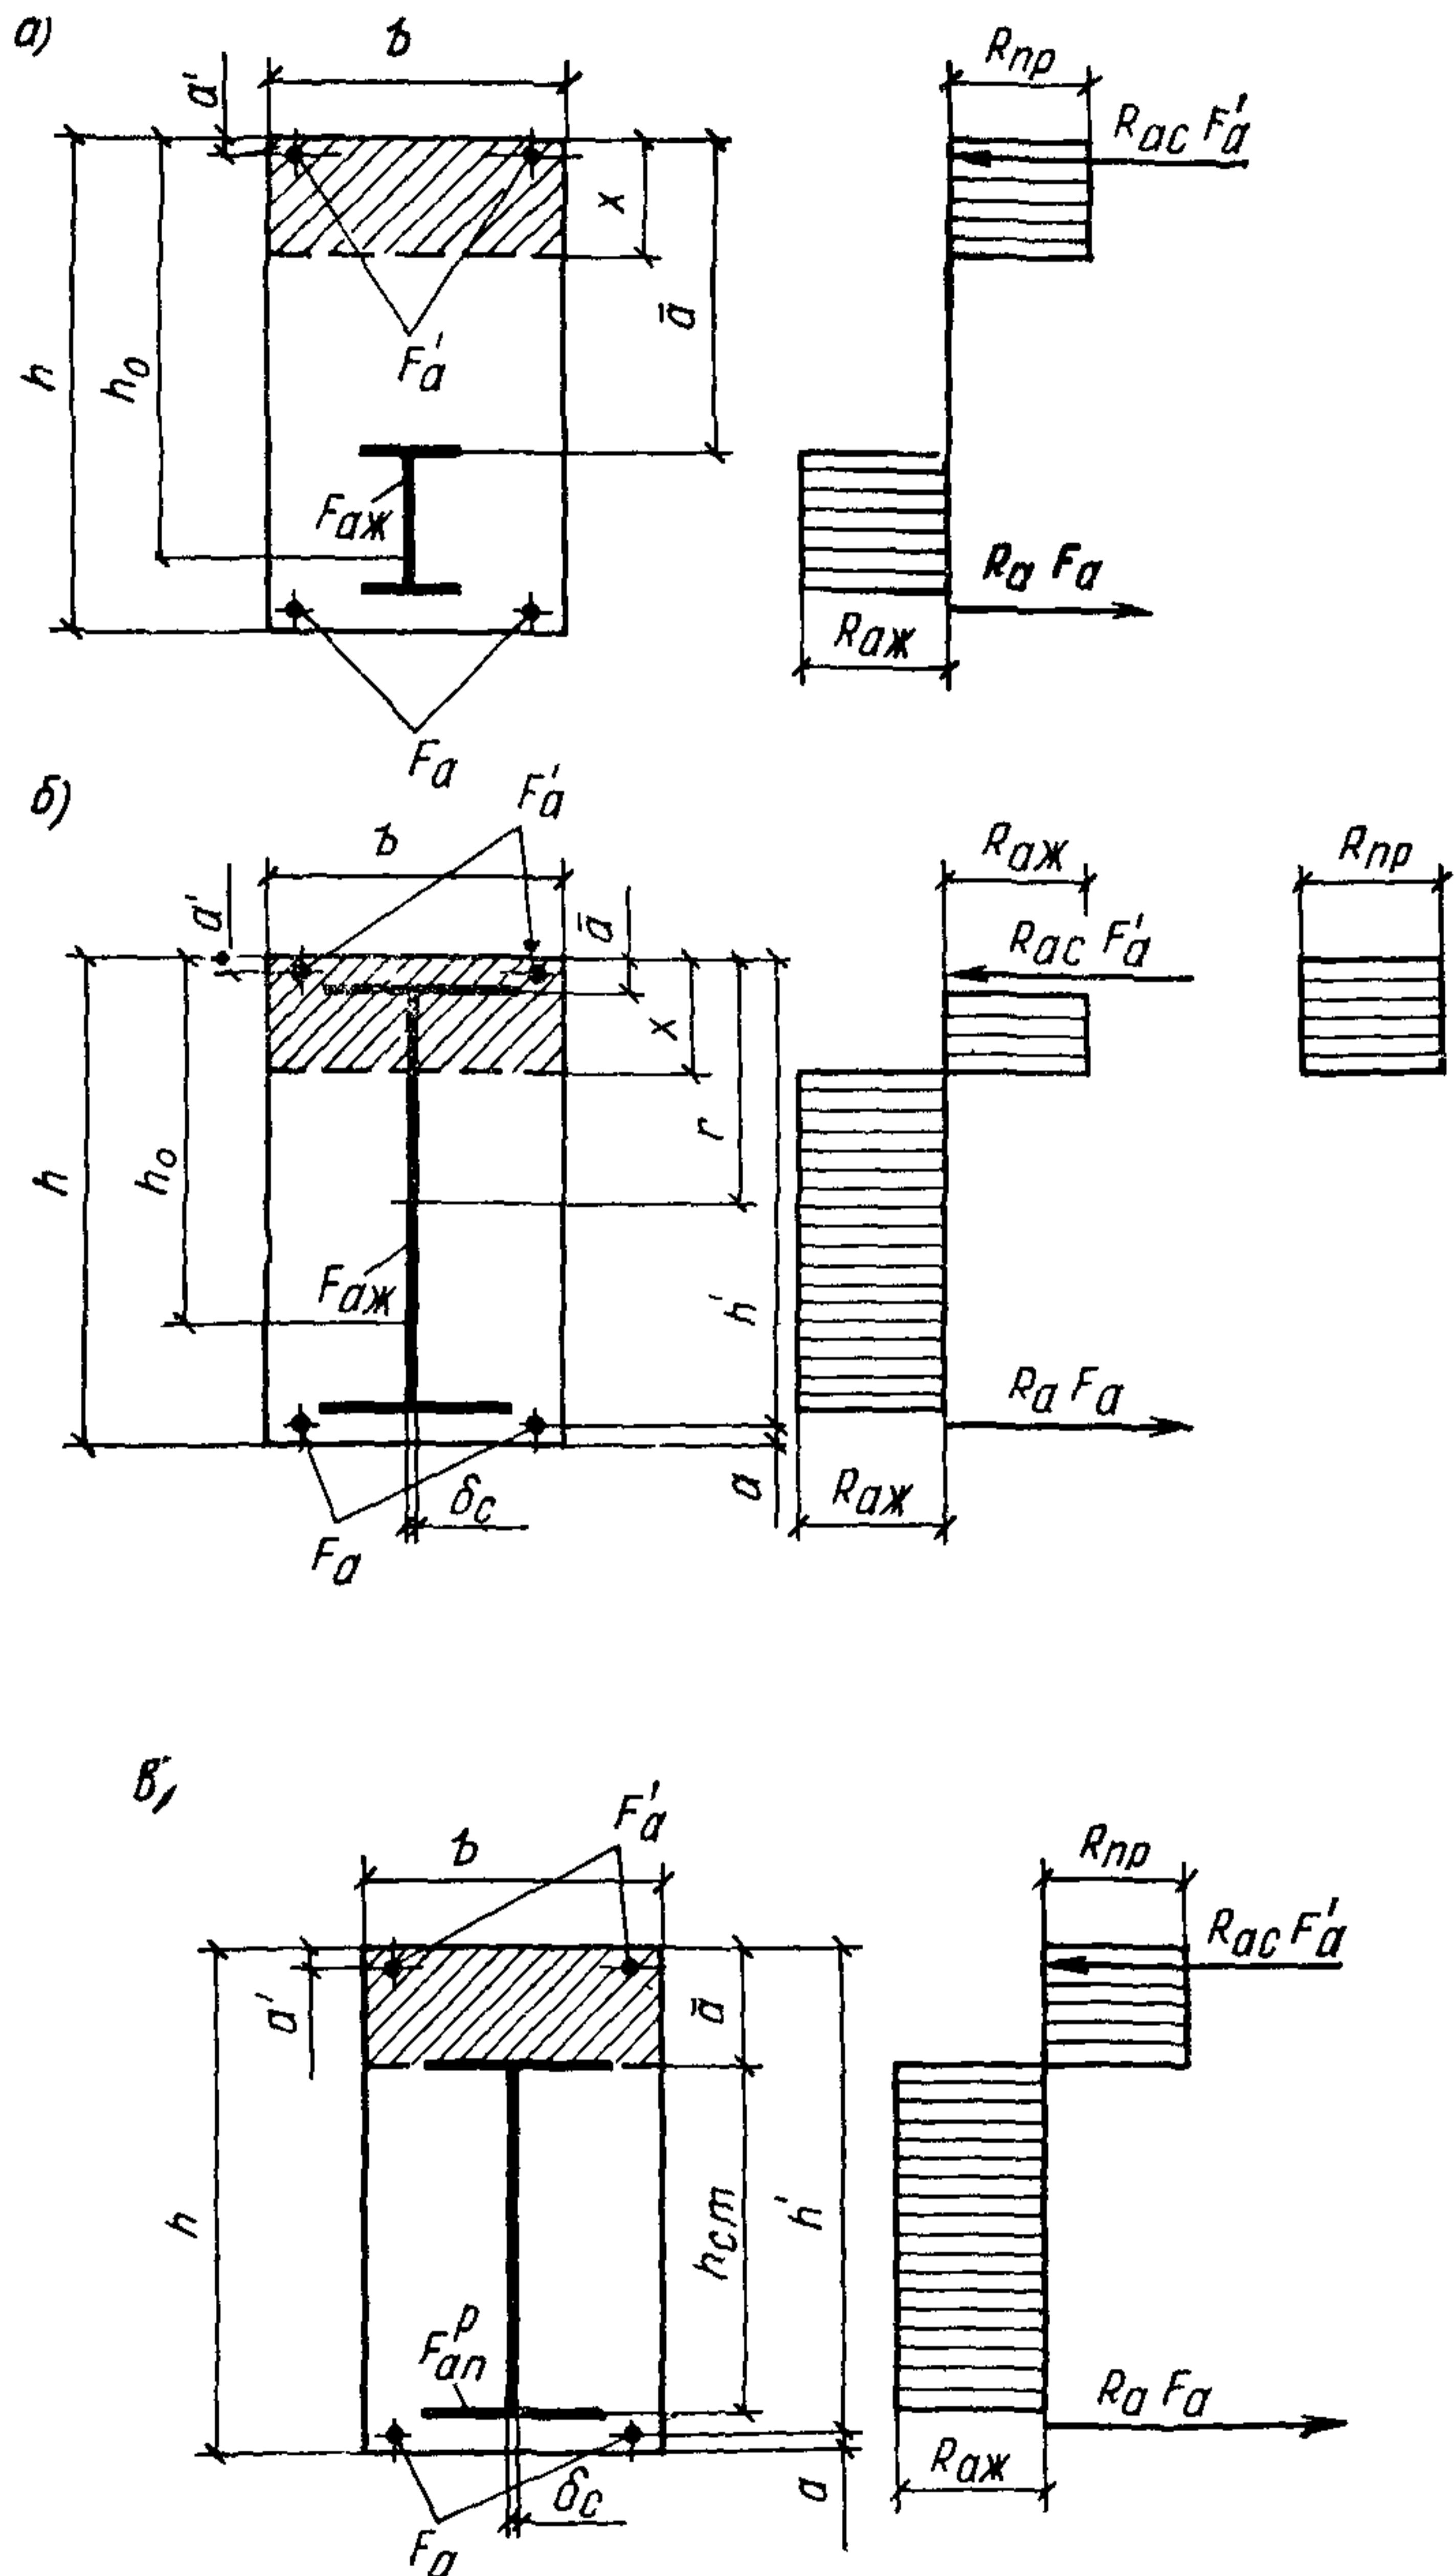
Случай расположения нейтральной оси для прямоугольного сечения
